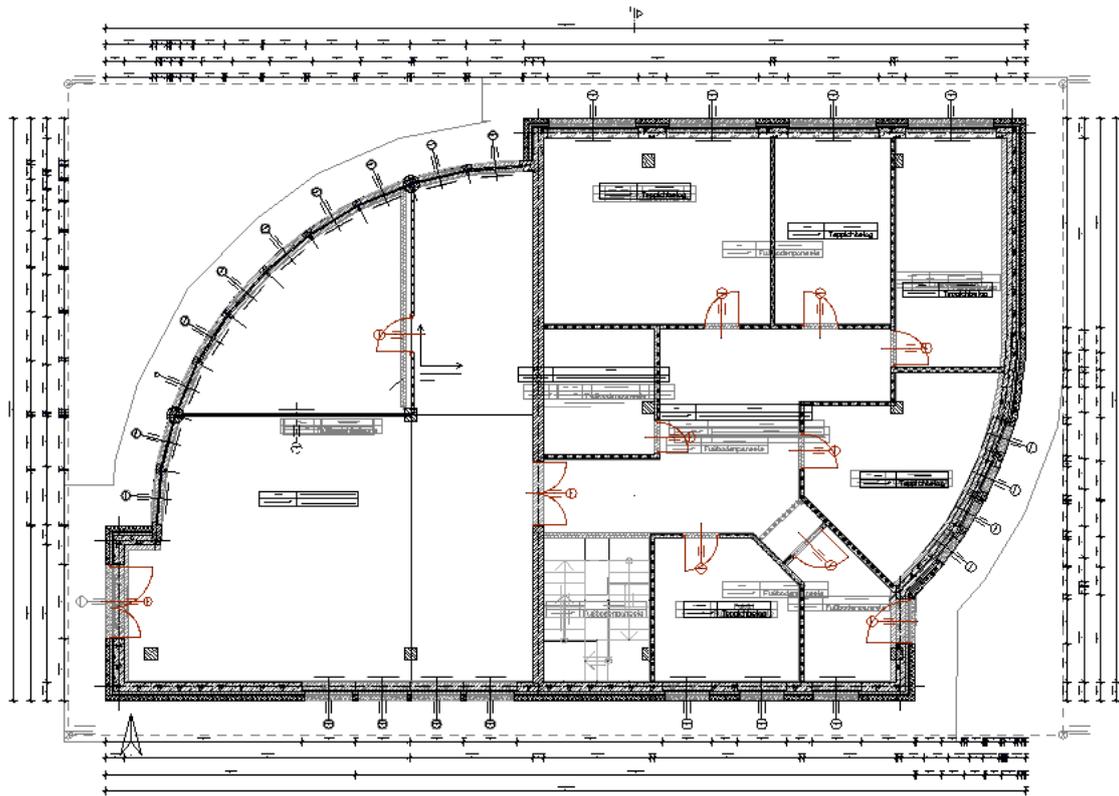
Grundriss eines Erdgeschosses mit der Voransicht der übrigen Geschosse des Projekts
